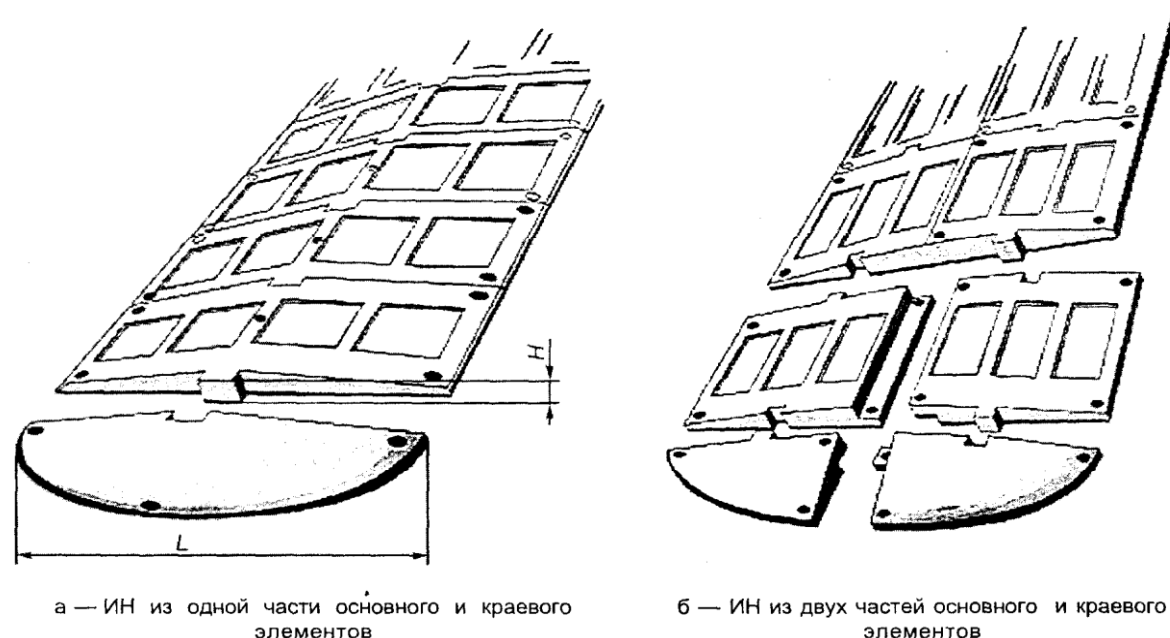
Конструкция сборно-разборной искусственной дорожной неровности
